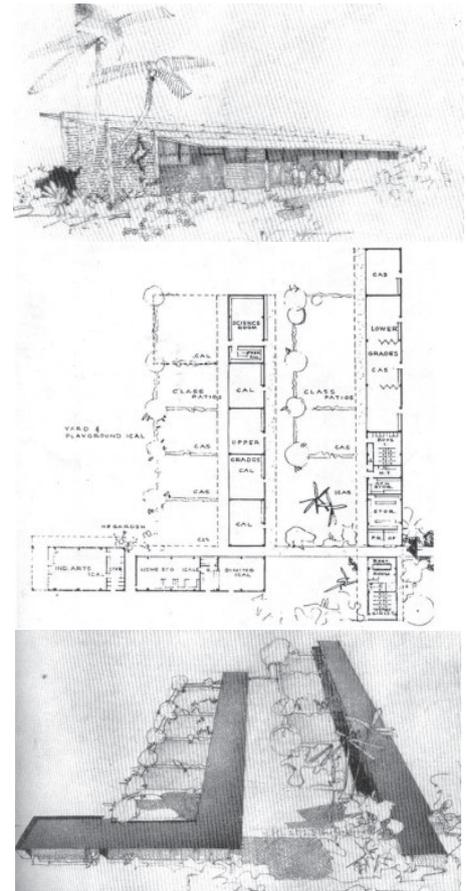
Croquis e planta para modelo de escola rural na América Central.
